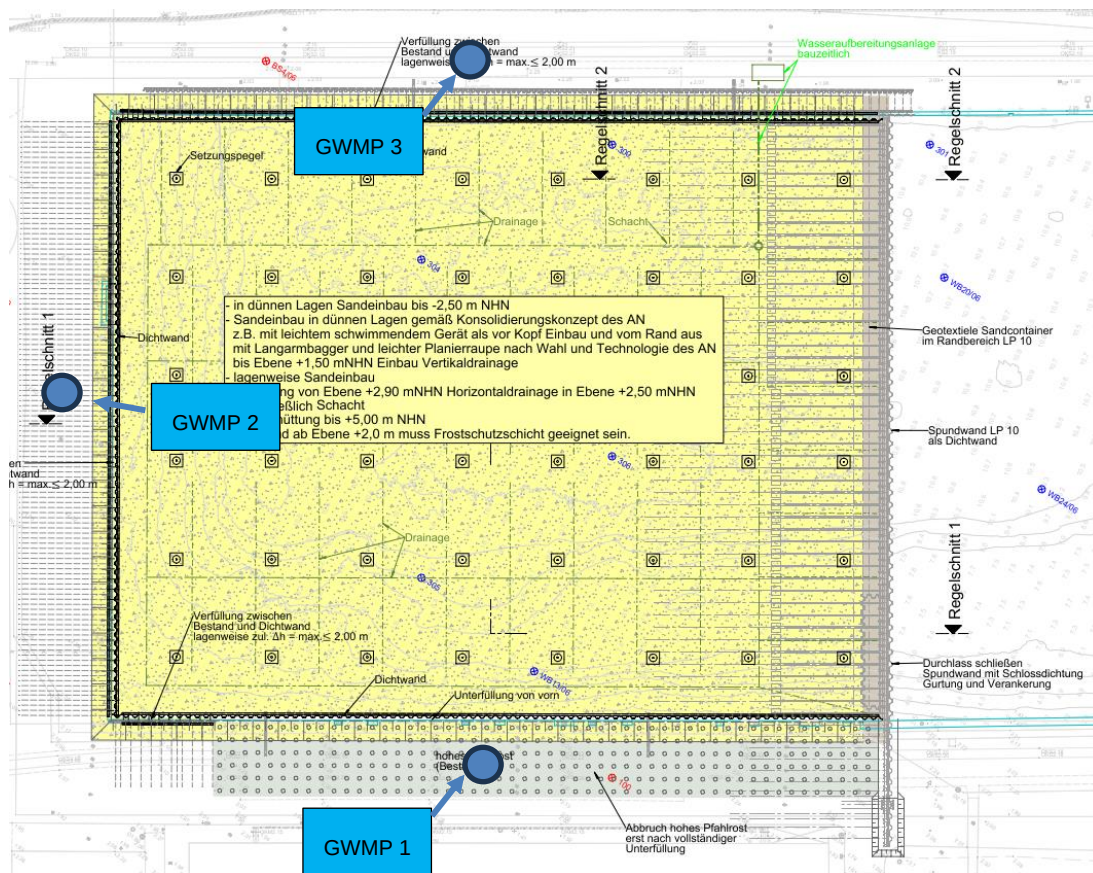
Lageplan – Grundwassermonitoringpegel (GWMP) Vorstellfläche
